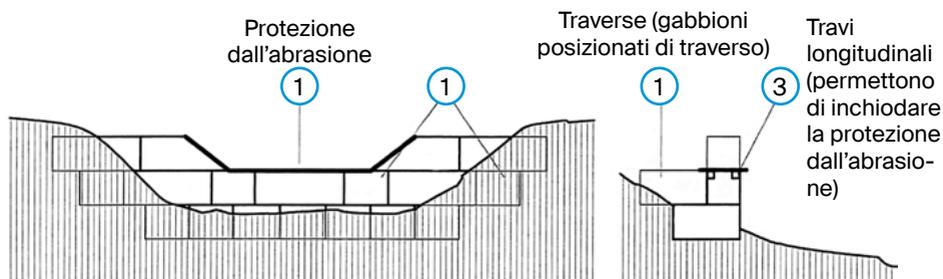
Briglia con gabbioni, variante A: prospetto e sezione (USTRA)
